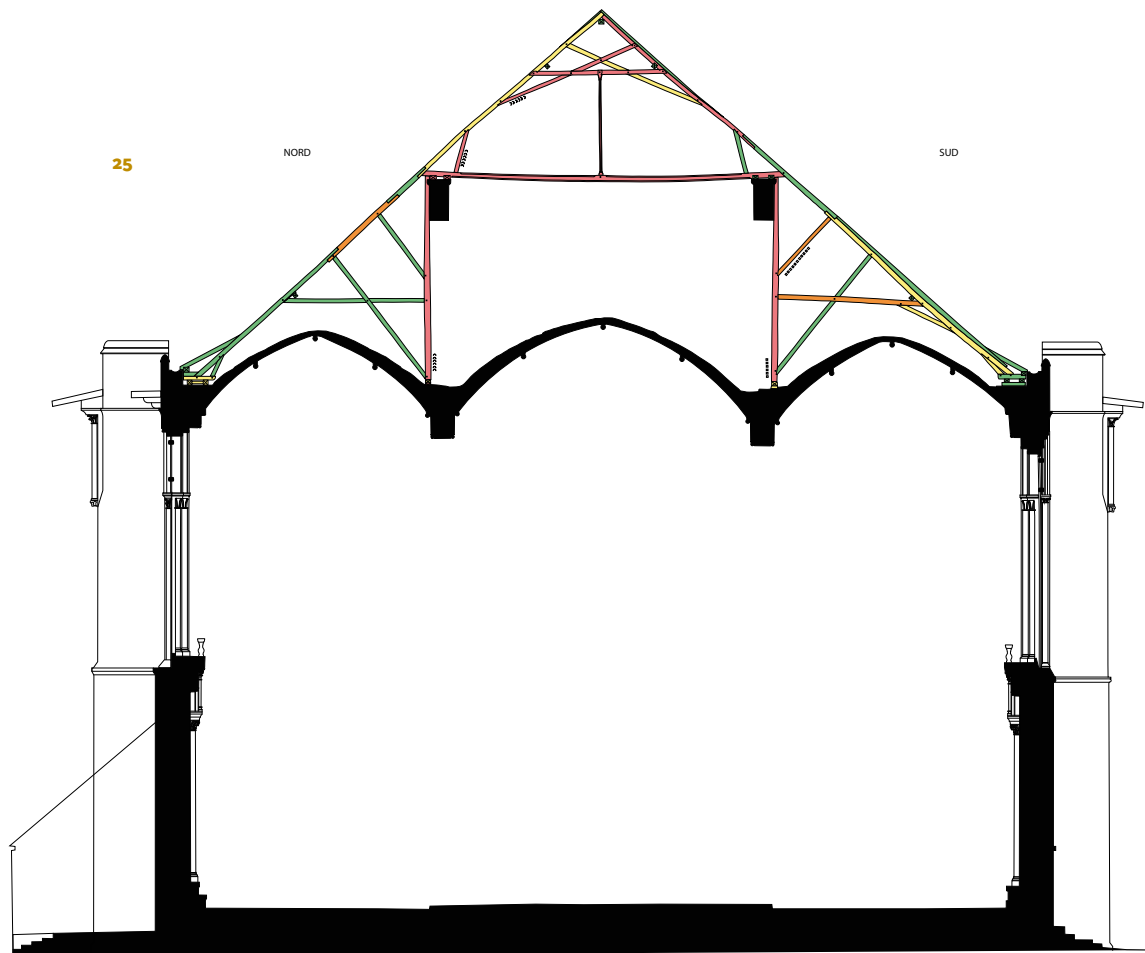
Coupe transversale du chevet au droit de la ferme principale 6, face ouest (relevé : F. E., ESGT ; DAO : F. E.).
